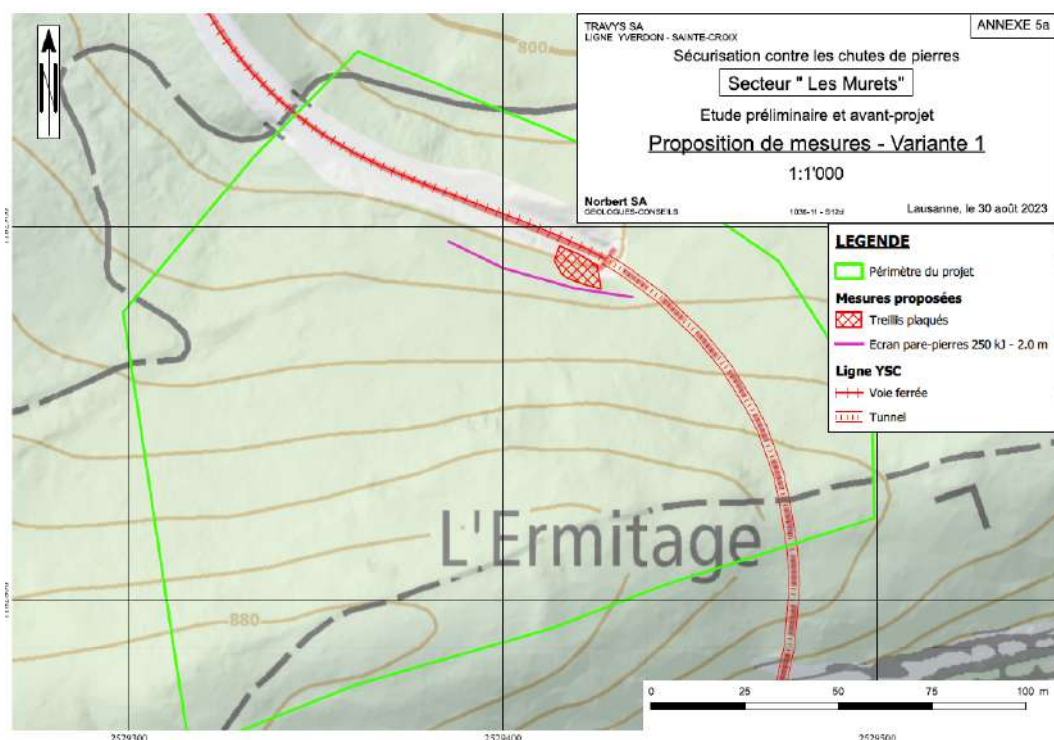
Carte de l'emplacement des mesures de protection dans le secteur "Les Murets". Source : Rapport géologique Norbert SA.
